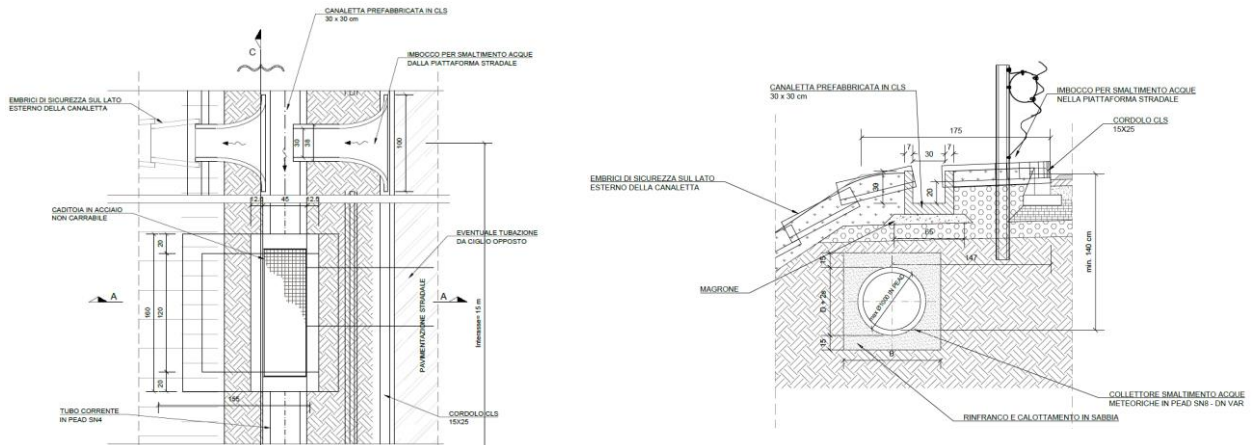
Tipologico scarico con embrici: pianta e sezione
